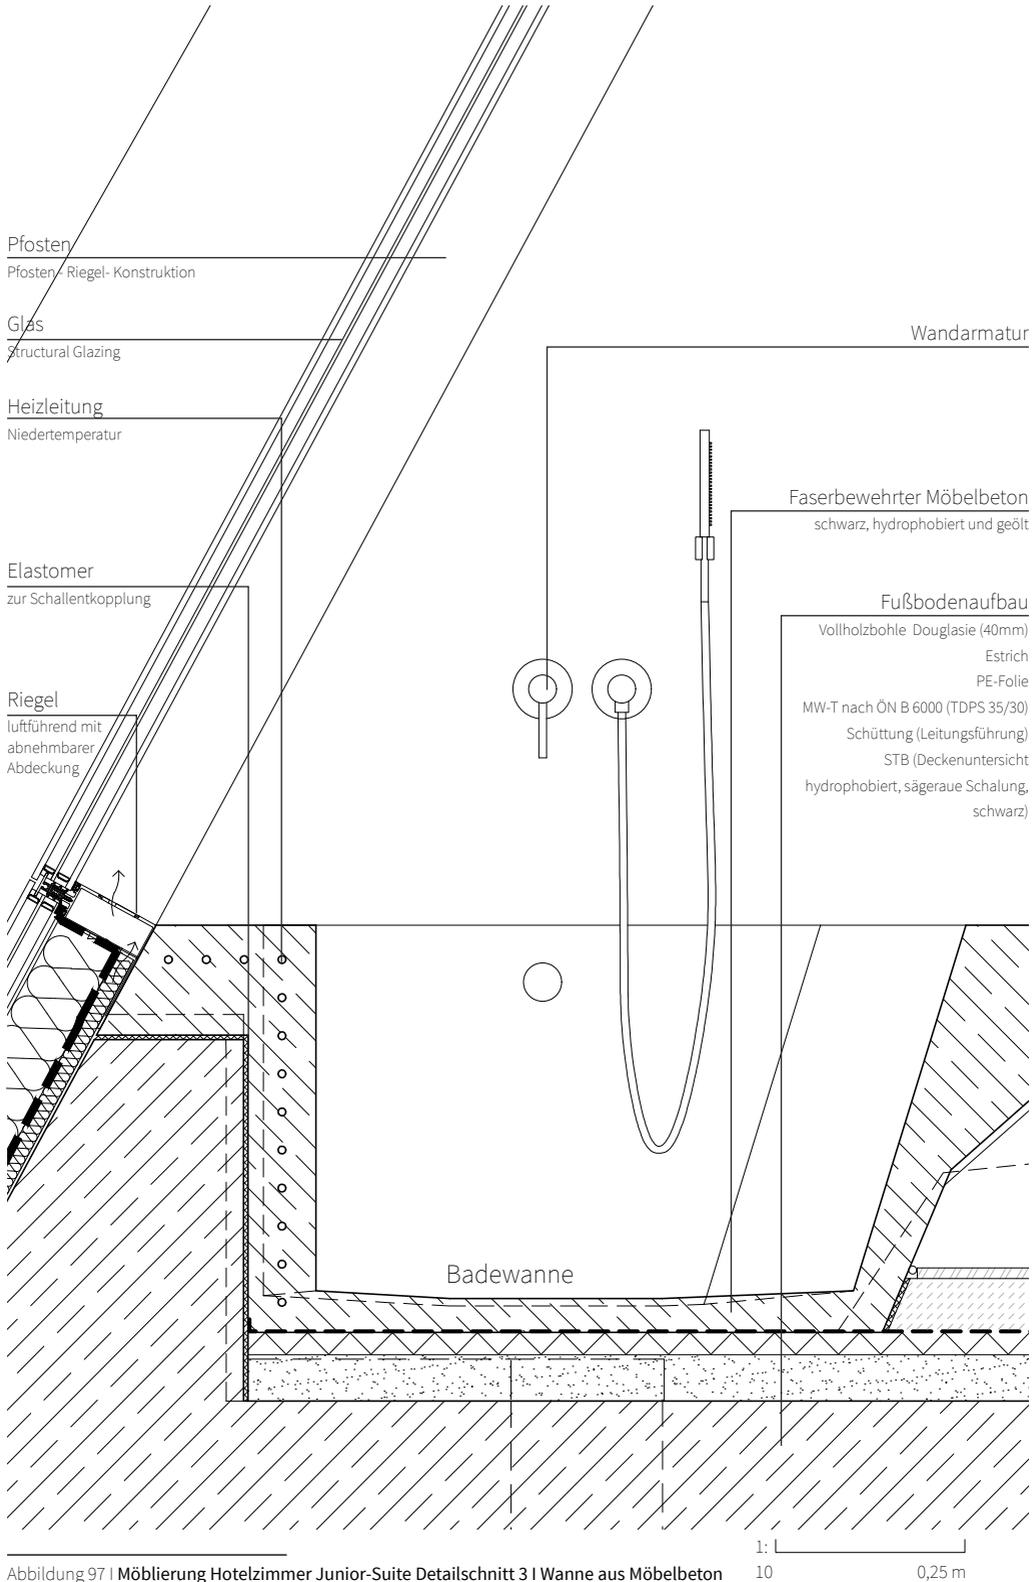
| Möblierung Hotelzimmer Junior-Suite Detailschnitt 3 | Wanne aus Möbelbeton
